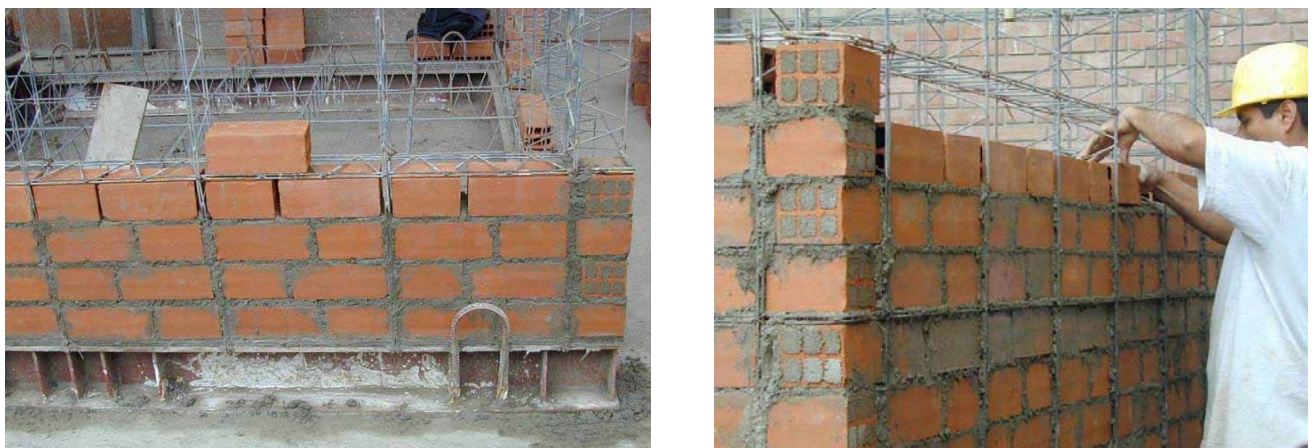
Para la construcción del muro de ladrillo hueco, se colocan las piezas dentro de la retícula de las cerchas previamente levantadas, pudiendo enfoscarse posteriormente.
